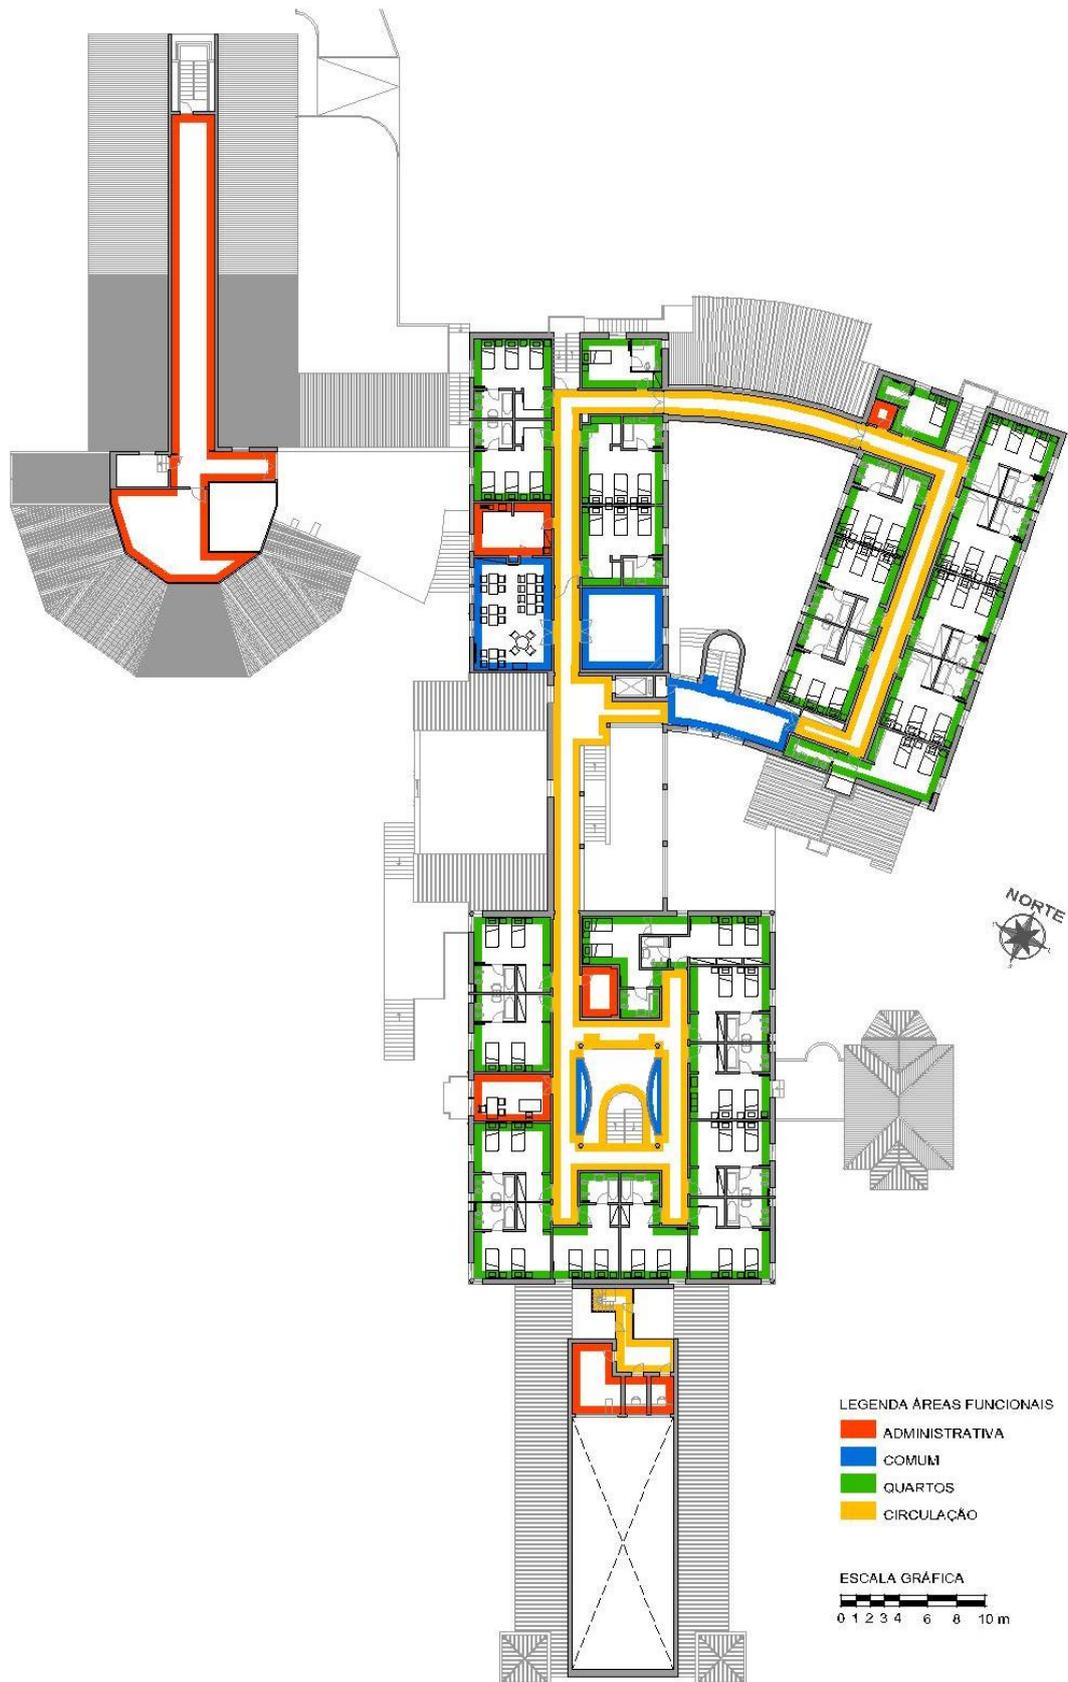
ILPI 1 - Setorização de áreas funcionais - 3º pavimento.
